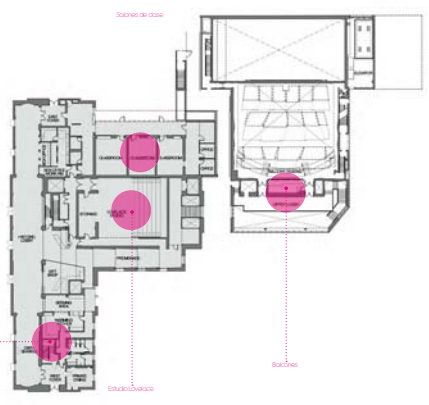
Planta interior1. Recuperado y editado de archdaily.com
